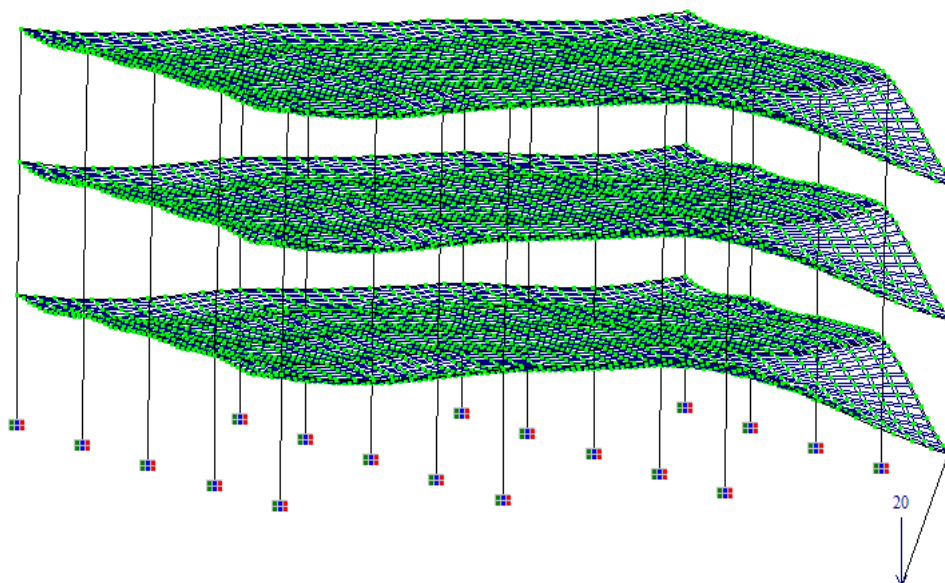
Schéma illustratif du comportement de la structure du bâtiment de 3 niveaux après le tassement du poteau d'angle
